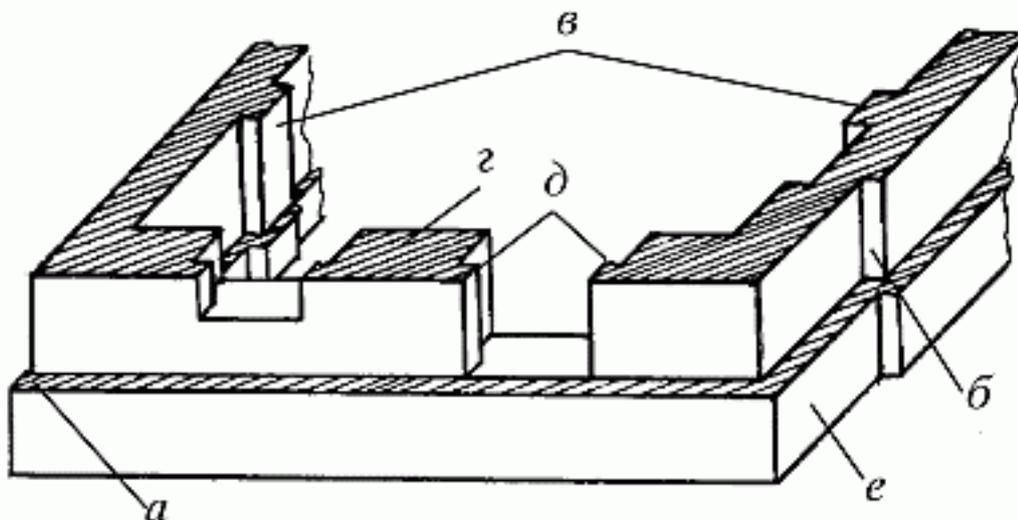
Детали каменных конструкций: а – обрез; б – уступ кладки; в – пилястры; г – простенок; д – четверть; е – цоколь
